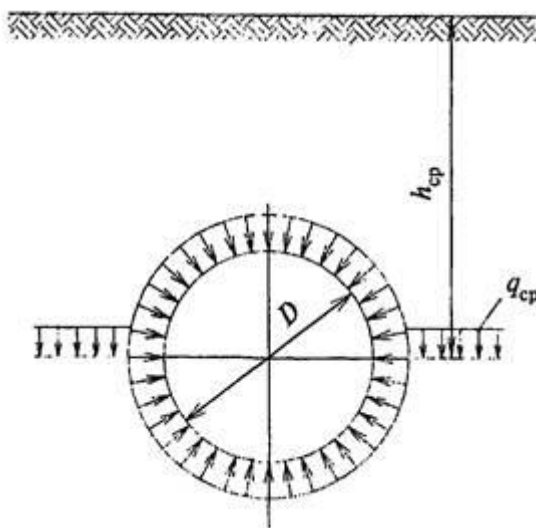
Среднее давление грунта на подземный трубопровод
